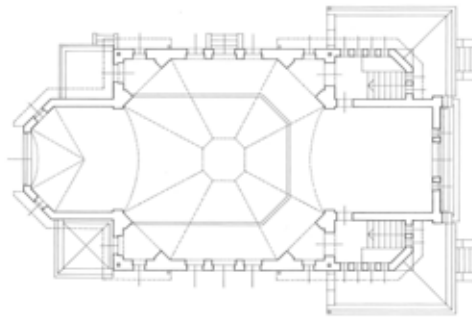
Grundriss – OG (Frauengalerie)
